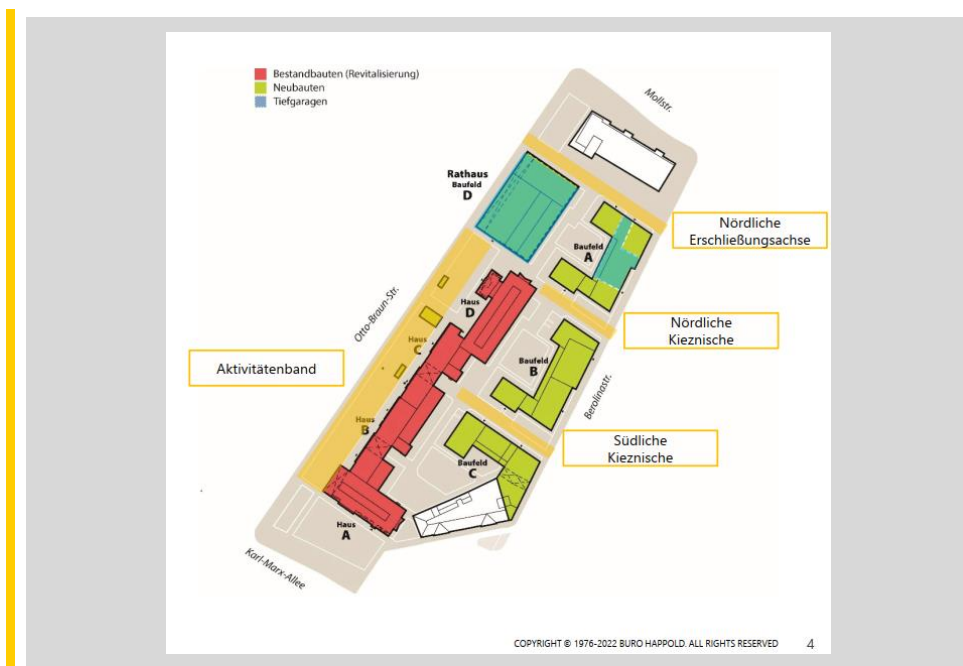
Lageplan Planungen Haus der Statistik³¹
